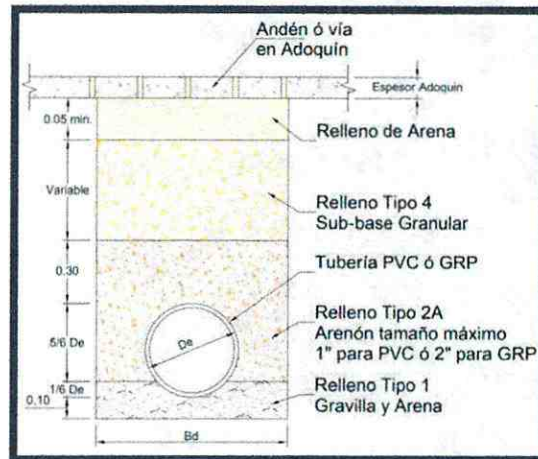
Cimentación típica de tubería para vías y andenes en adoquín
